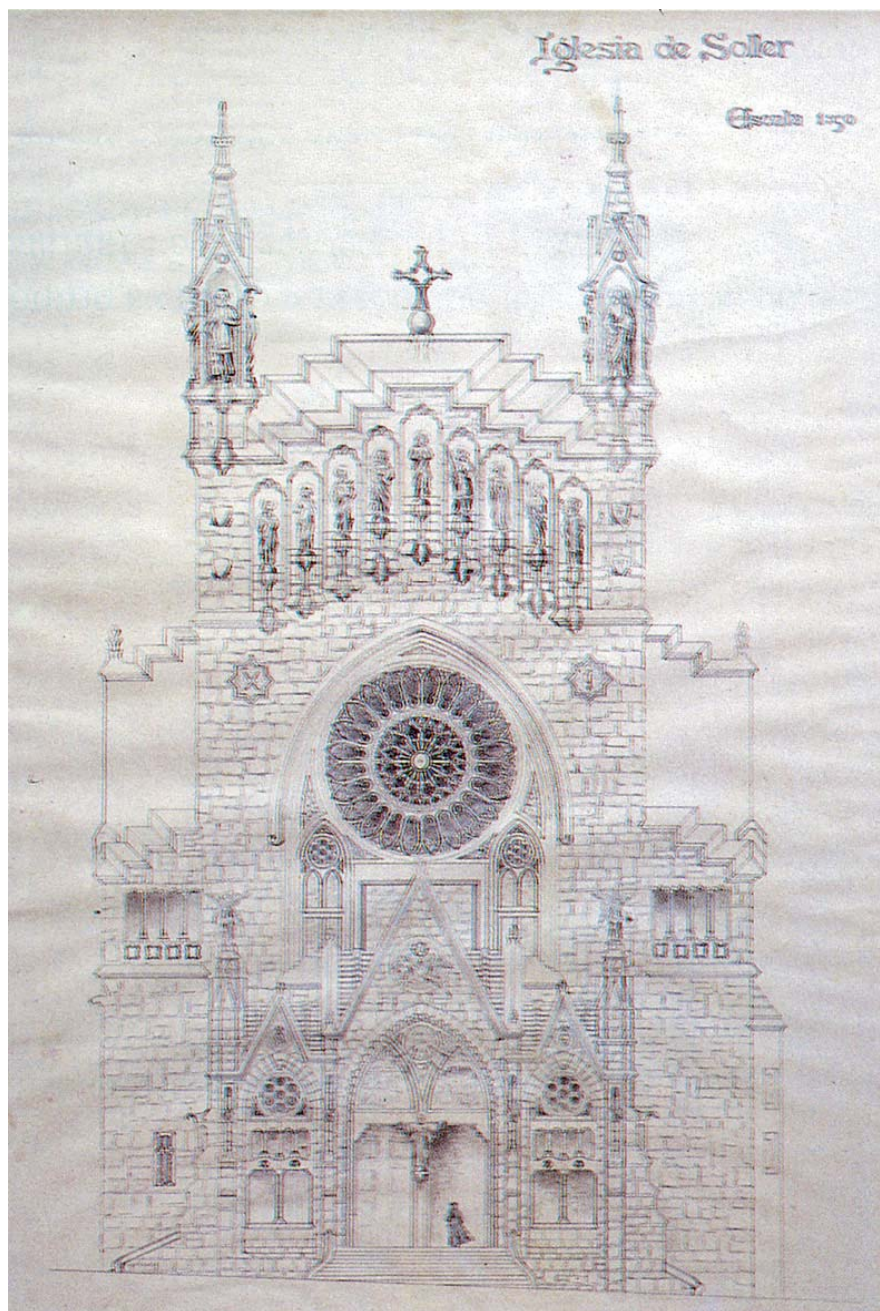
Proyecto definitivo para la fachada de la Parroquia de Sant Bartomeu, 1905. [Morell, 1993].
